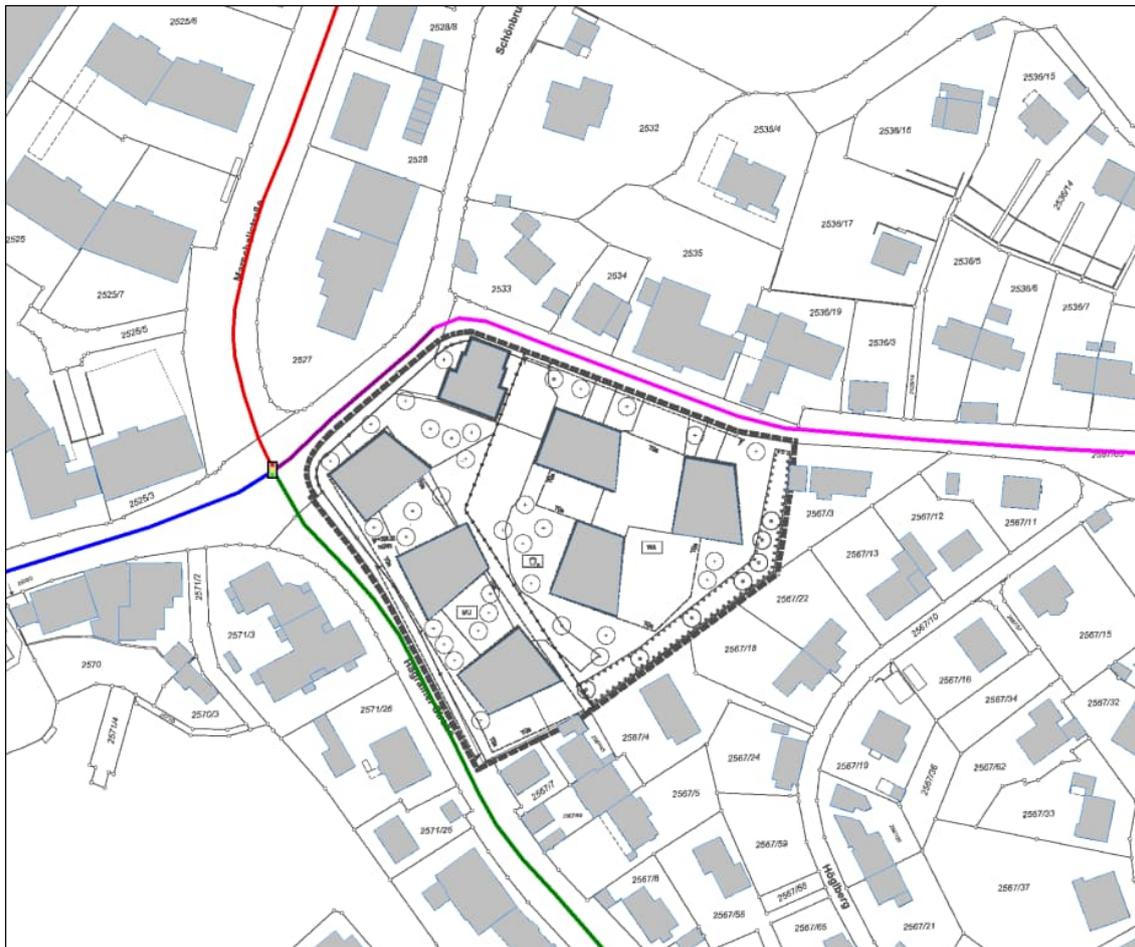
Lageplan mit Darstellung der relevanten Straßen
